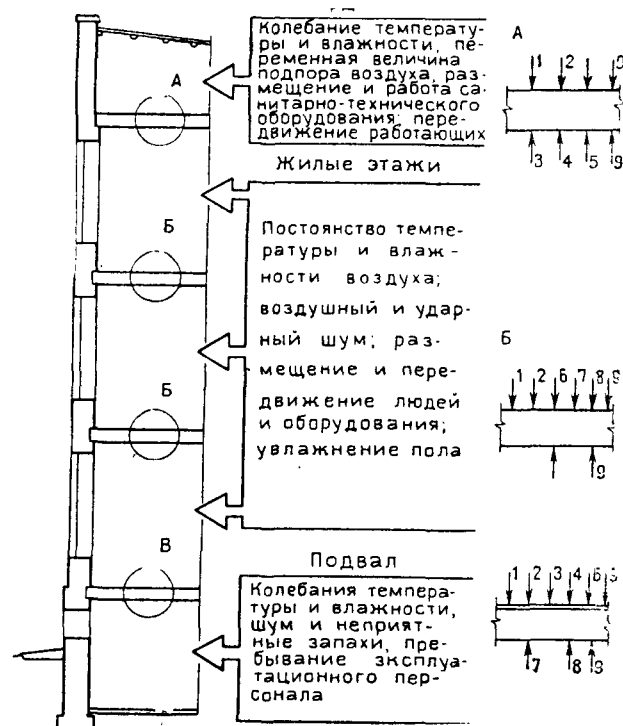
Условия среды и определяемые ими воздействия на перекрытия
